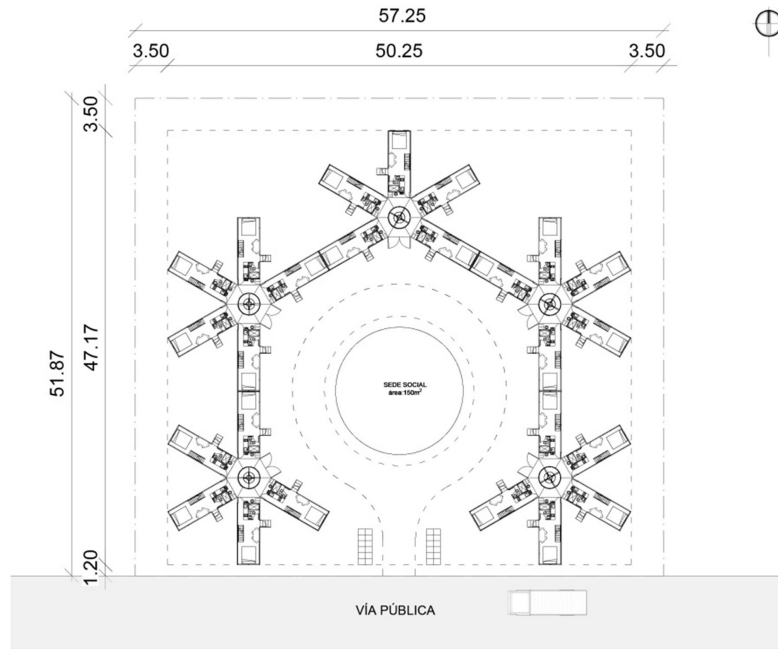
Esquema 1 terreno conectado a 1 vía.
